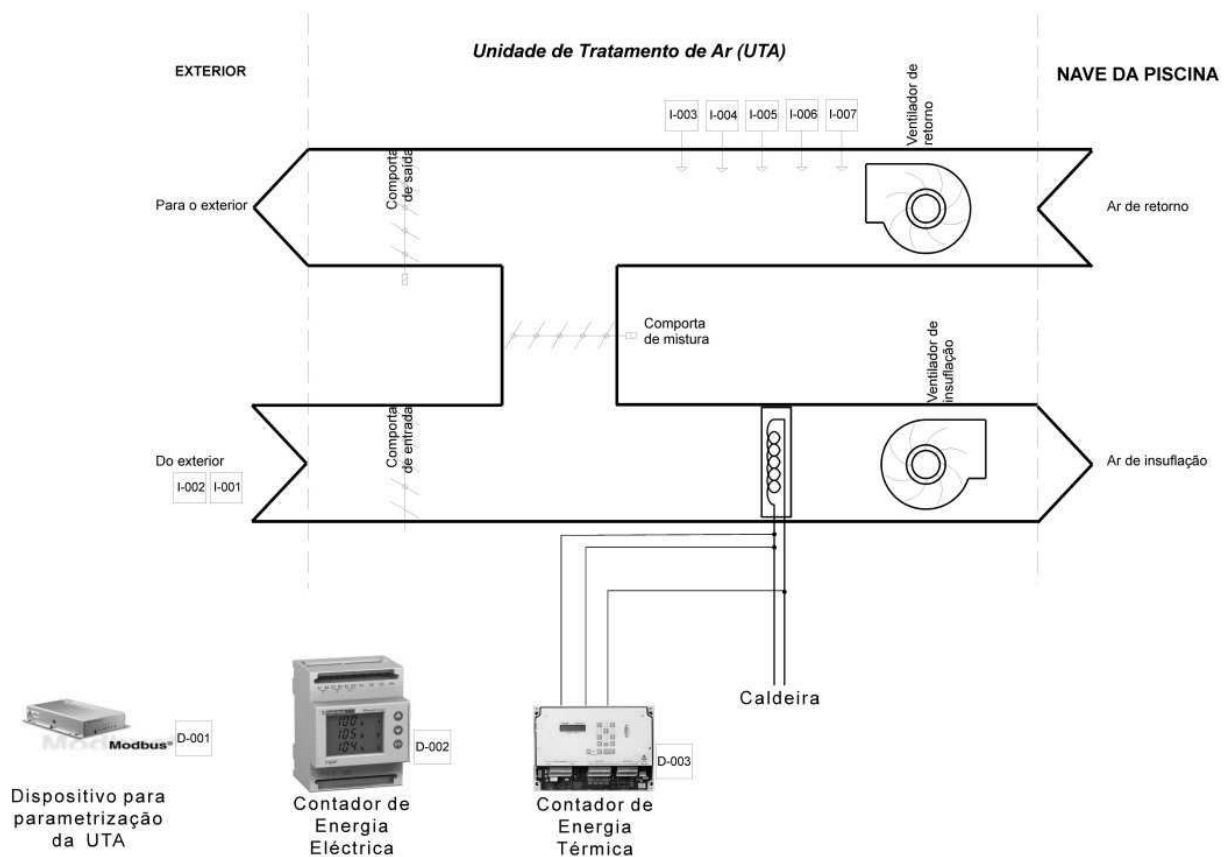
Planta de pormenor de localização dos sensores na UTA
